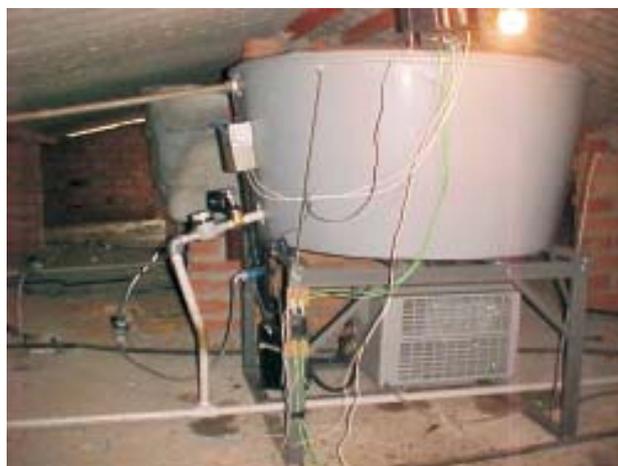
Detalhes do sistema de aquecimento, instalado, e tubulações hidráulicas e de fluido refrigerante.
